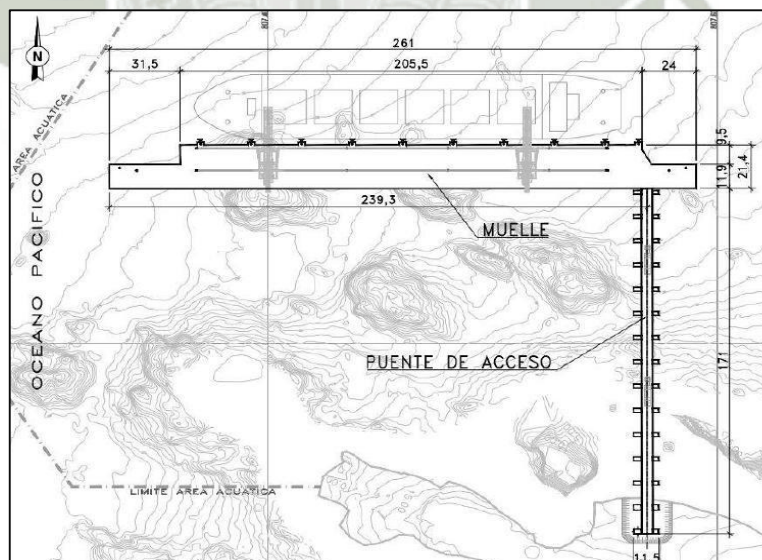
Planta general del puente y muelle (Proyecto Matarani, 2013)
